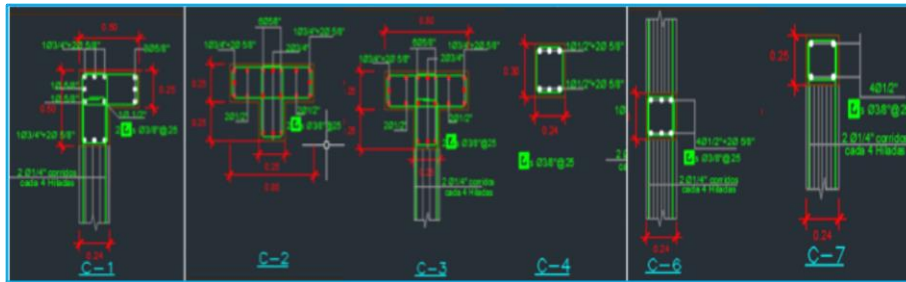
Detalle de las dimensiones de las columnas y el acero de refuerzo
